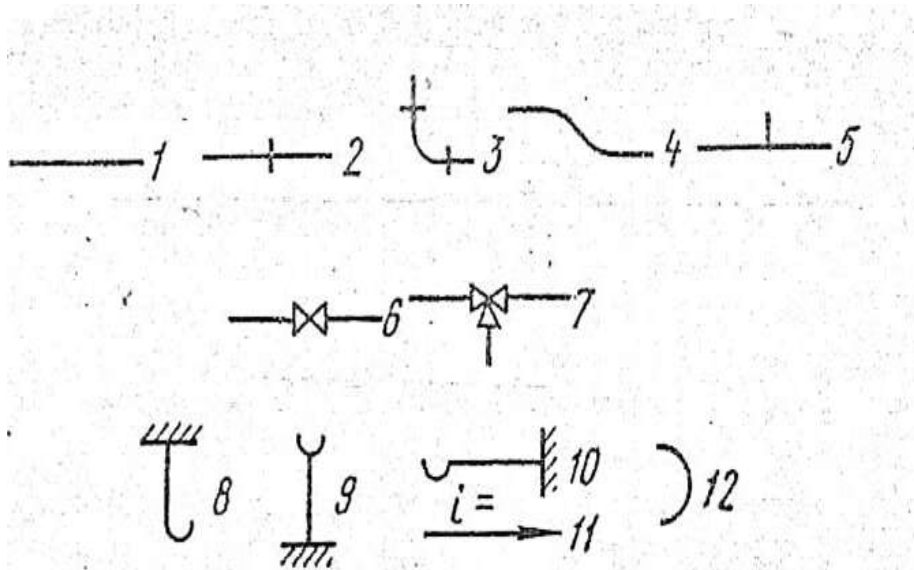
Условные обозначения на схемах трубопроводов для молока:
